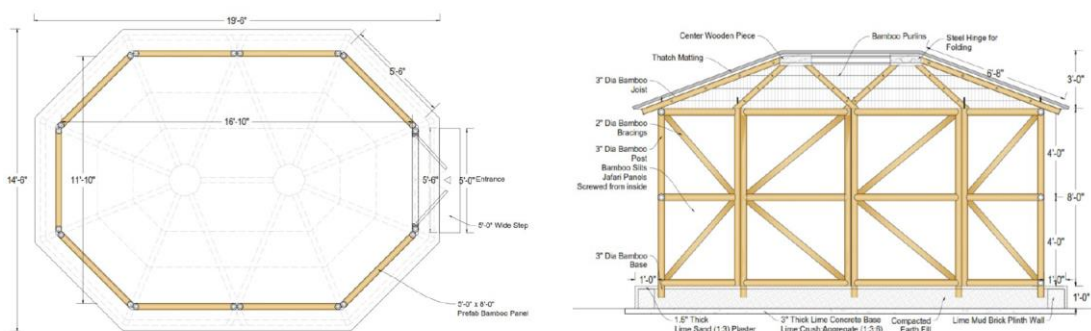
Grundriss und Schnitt des doppeloktogonalen Schulgebäudes (Quelle: Haider, 2022)
